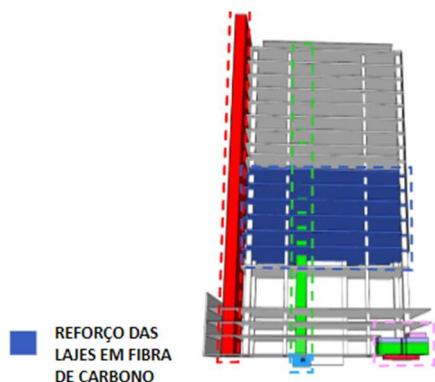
Pavimentos em que foram aplicados o reforço das lajes em fibra de carbono.
